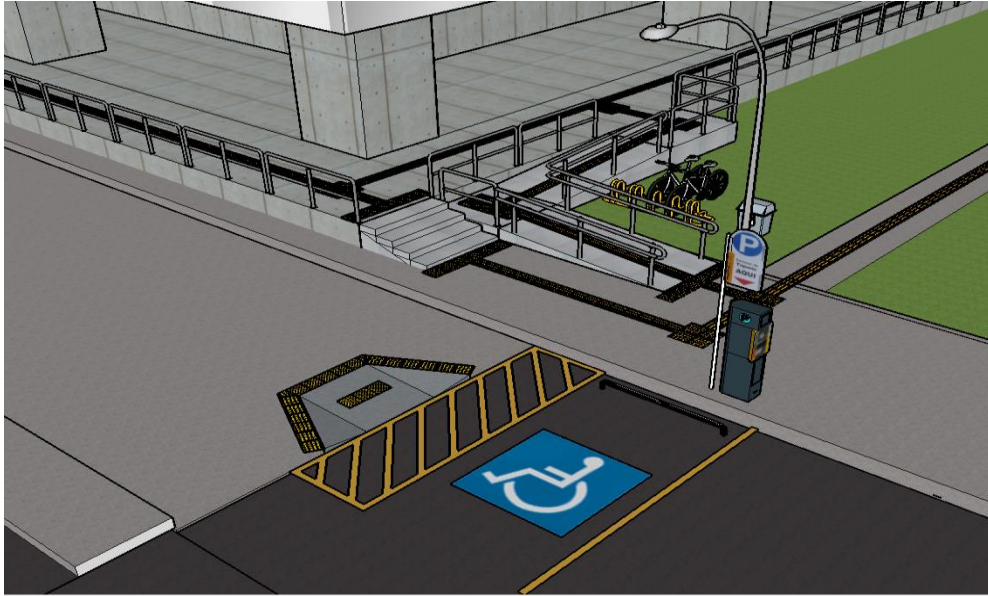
Vistas transversais do acesso do cadeirante pela rampa padronizada com piso tátil instalado
